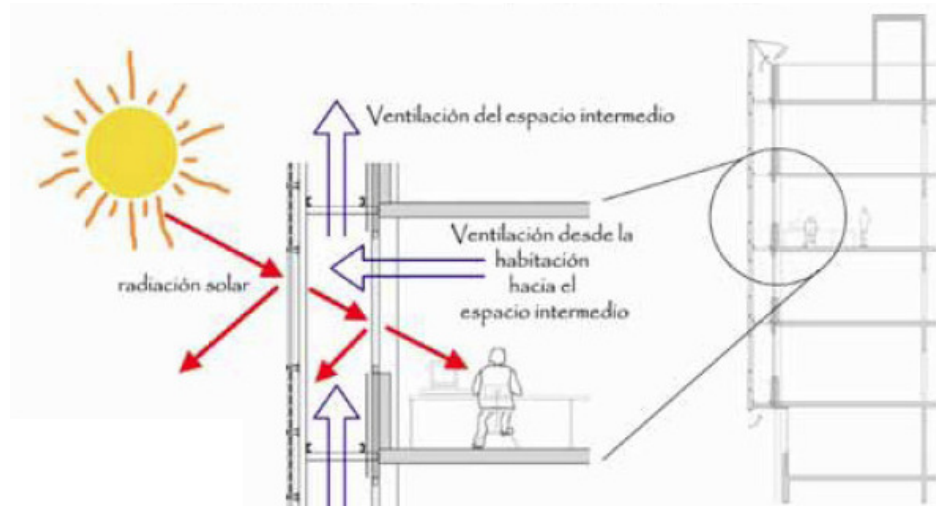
Comportamiento de doble fachada frente a la radiación solar y ventilación.
